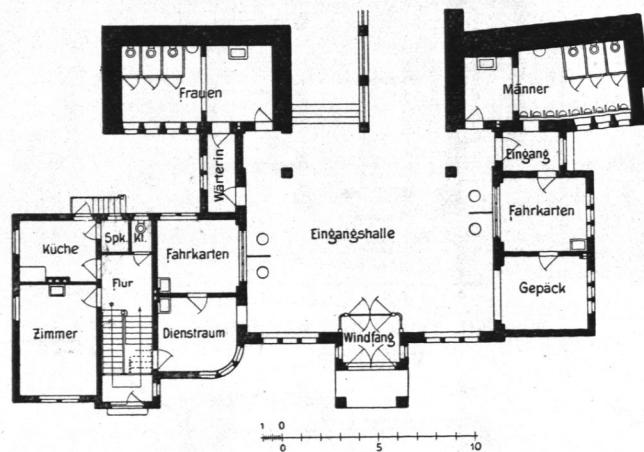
Haltestelle Barmbeck, Erdgeschoß.
